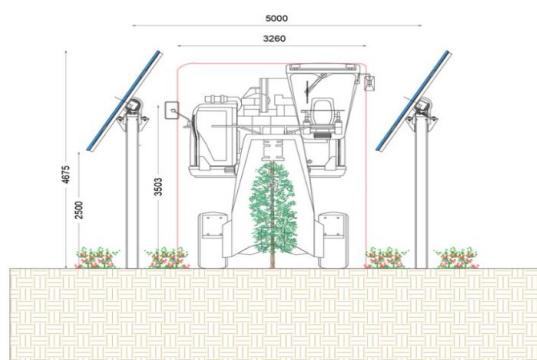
Sezione dell'area dell'impianto con indicazione delle scelte progettuali
